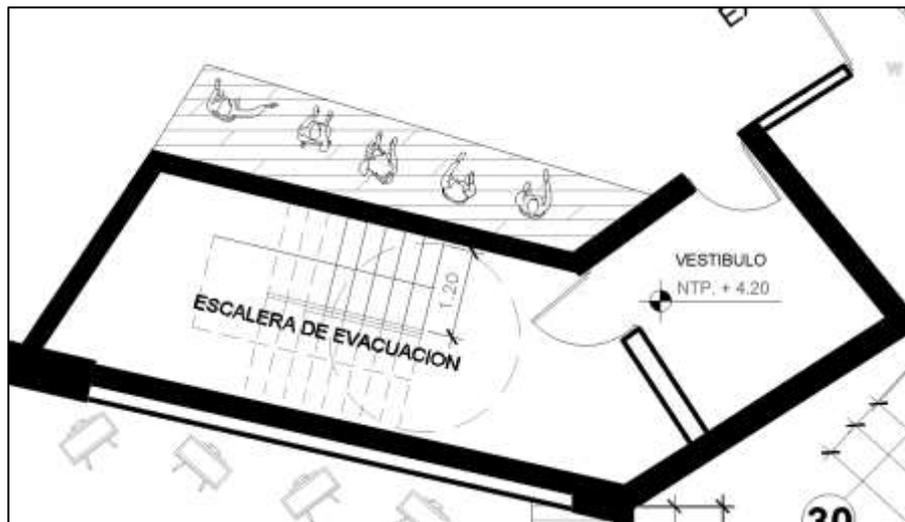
Planta segundo nivel del proyecto-galerías- escalera de evacuación.
